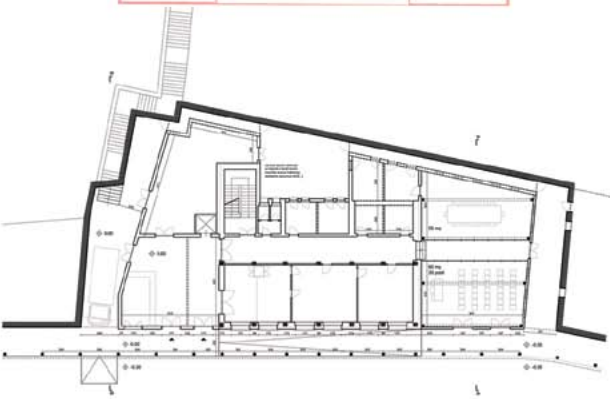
ex scuola di Sampeyre - rilievo stato di fatto - pianta piano terra - DICAS]
